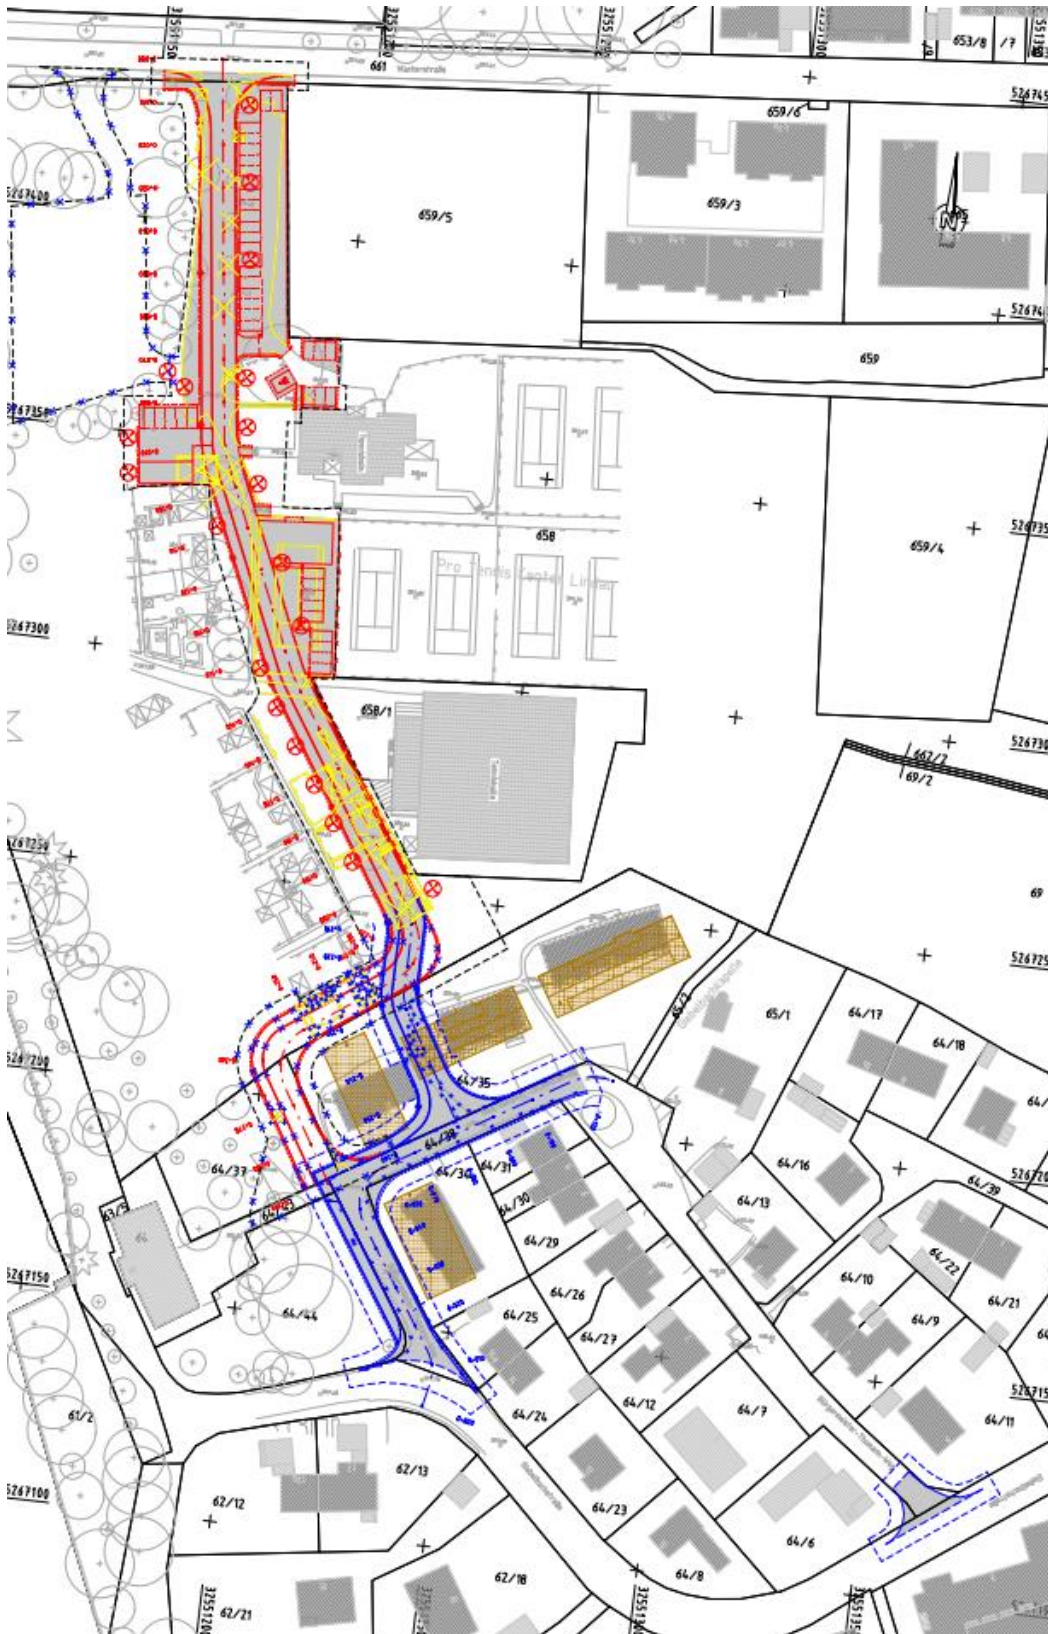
Übersichtslageplan Straßenneubau , Variante 5i (rot und blau), Rückbau (gelb), Plan von WKP Planungsbüro für Bauwesen GmbH, 2022
